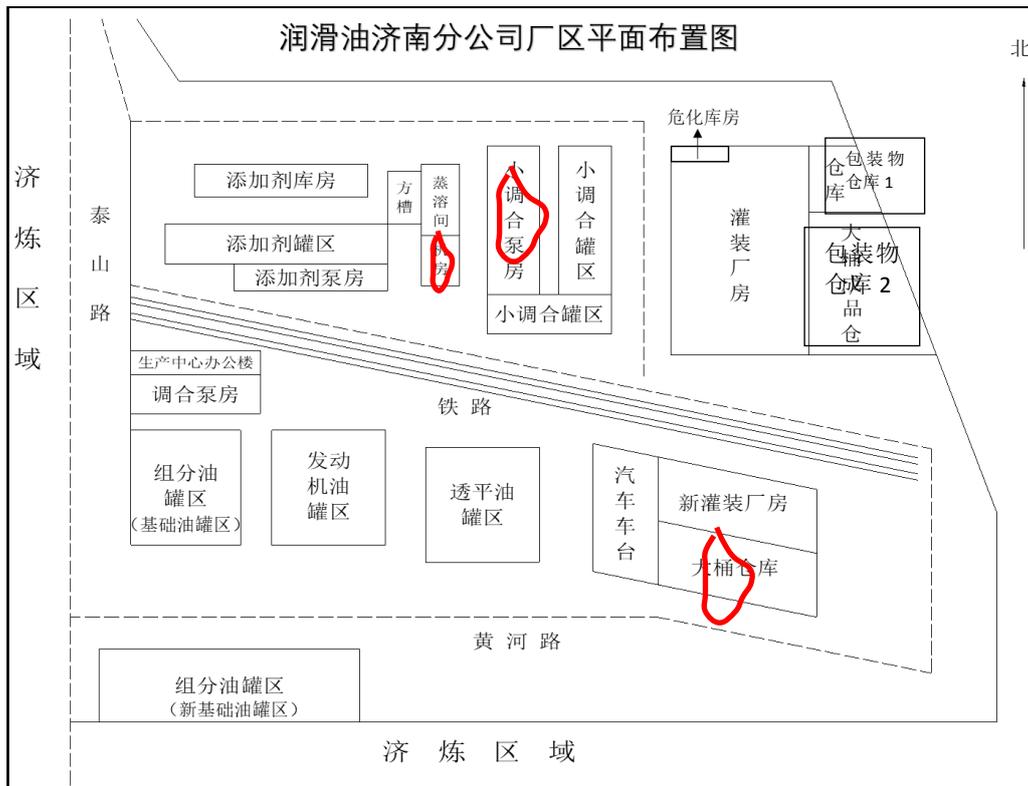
润滑油济南分公司厂区平面布置图（平面图错误太多）
